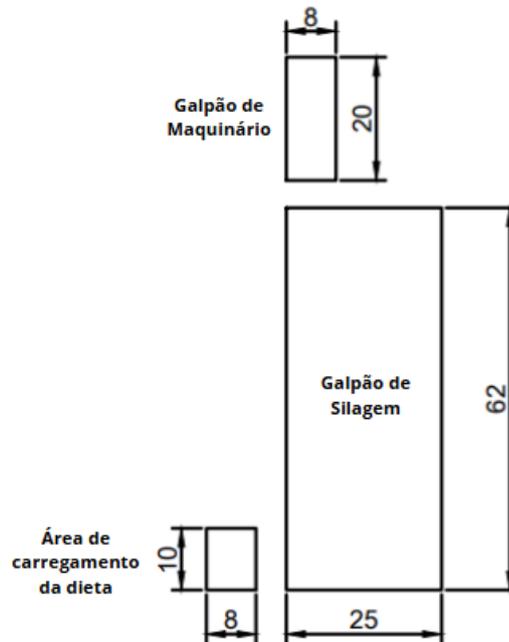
Dimensões dos Galpões de Silagem e Maquinários
